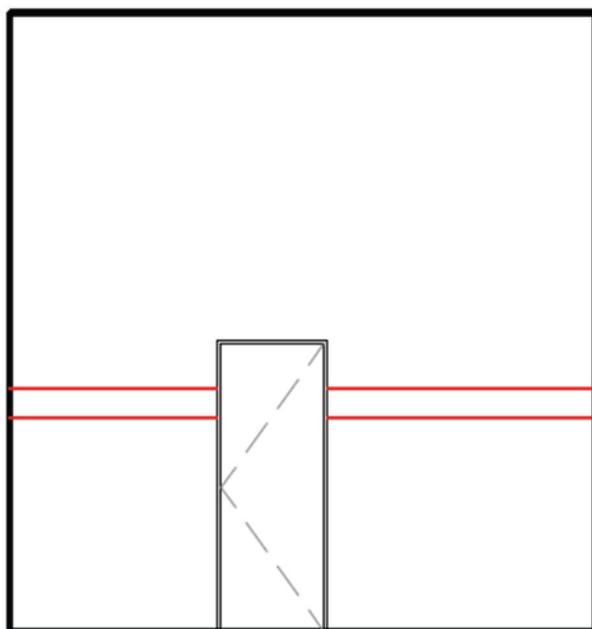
Elevação da prospecção arquitetônica 5 na parede
